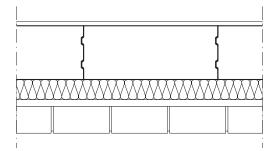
Двухслойные наружные стены из блоков YTONG с навесным вентилируемым фасадом
